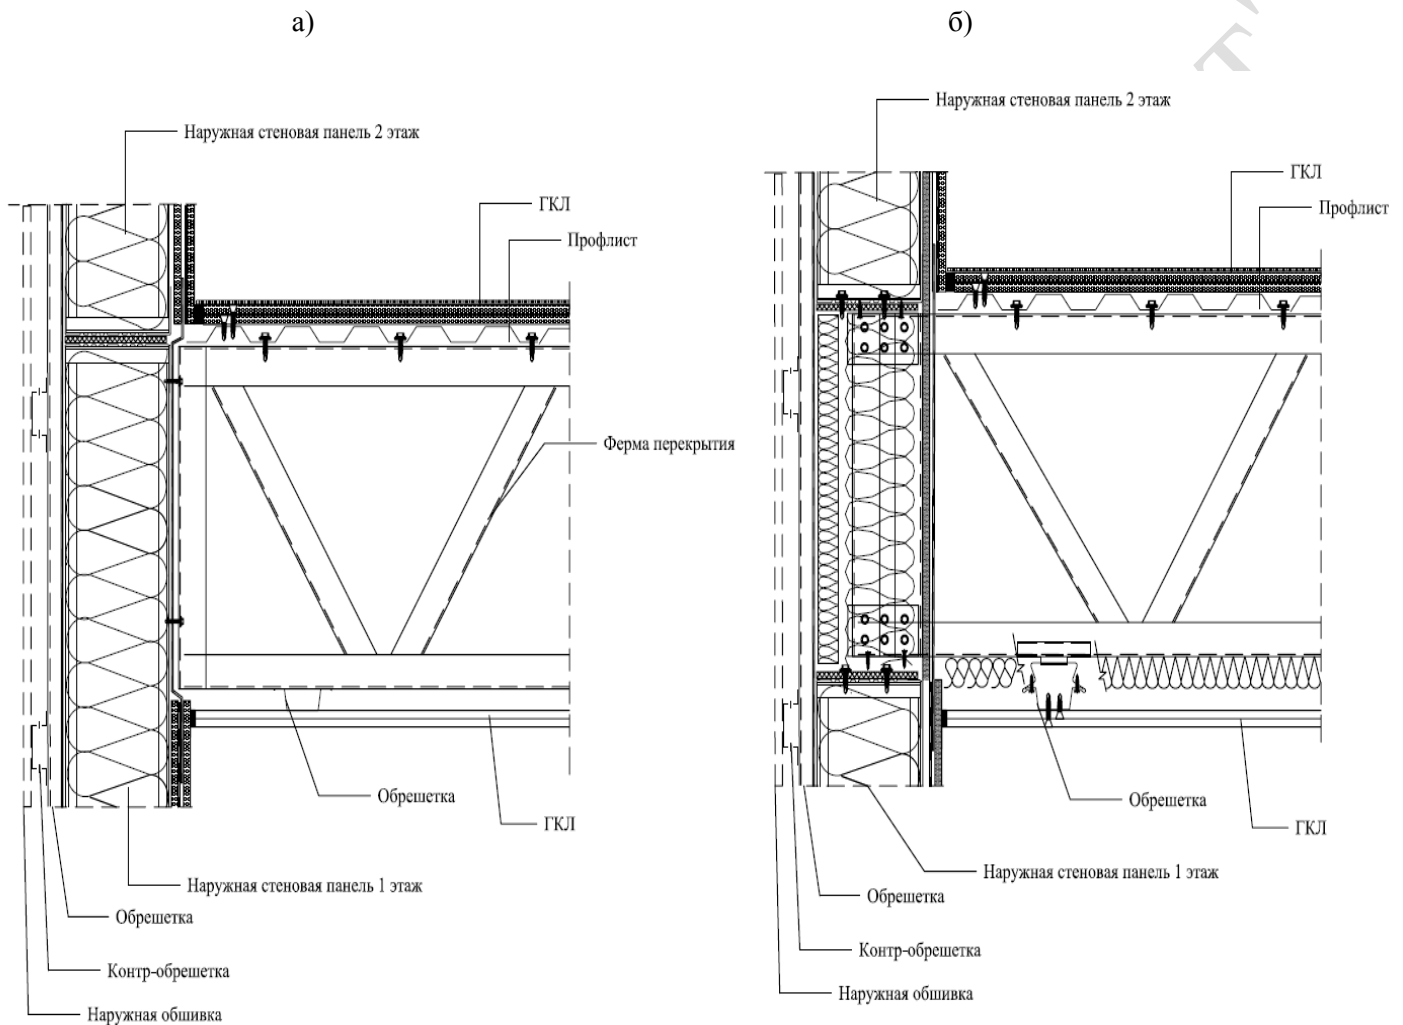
Узлы соединения междуэтажного перекрытия с наружной стеной:
